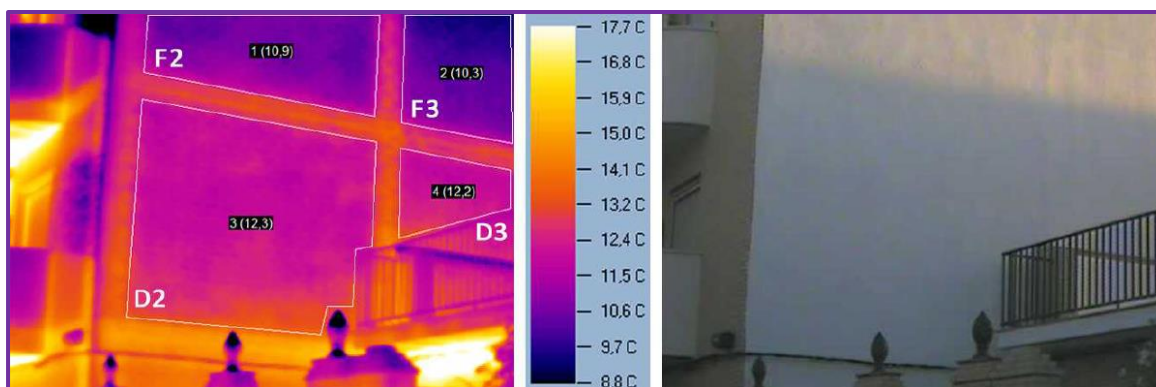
Termografía de la fachada sur (Fig. 4.31 de Facchini, 2014)
